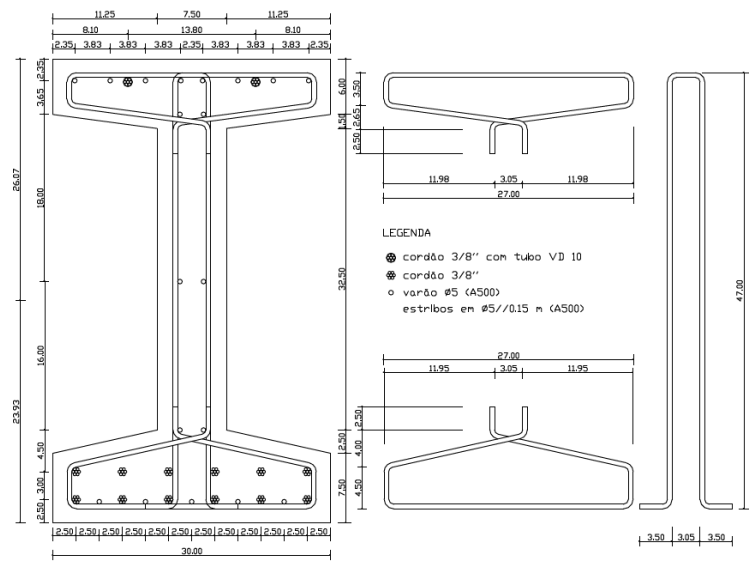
Desenho pormenor da secção da viga de betão armado de alta resistência pré-esforçada, adaptado de Fernandes (2005)
